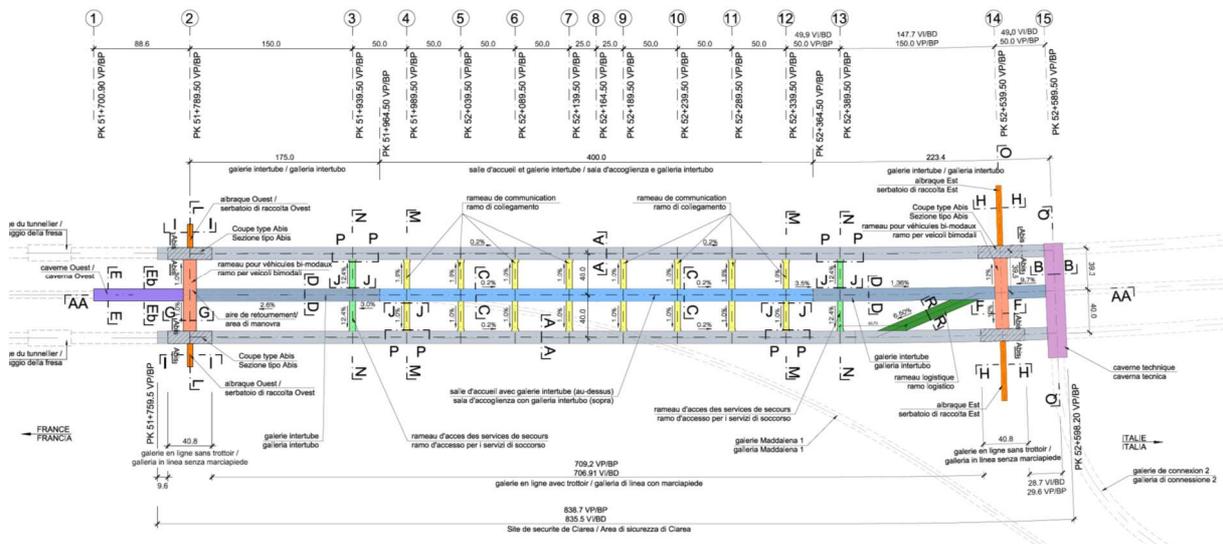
Configurazione planimetrica dell'area di sicurezza
